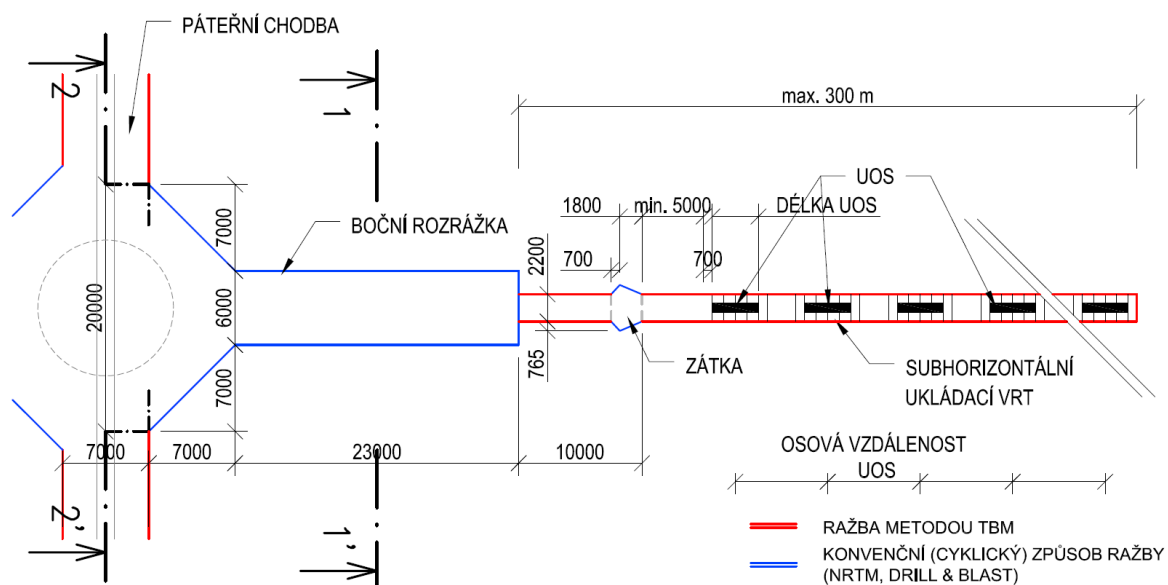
Půdorysné schéma ukládání – varianta D3
